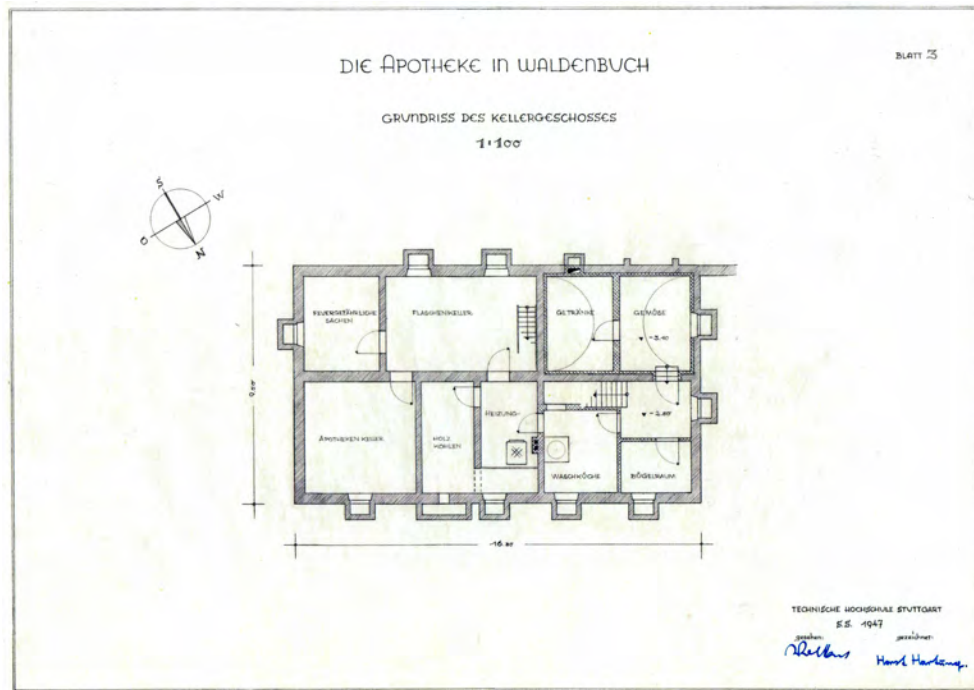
Zweiter Entwurf: „Apothek in Waldenbuch“, Grundriss der Kellerräume
